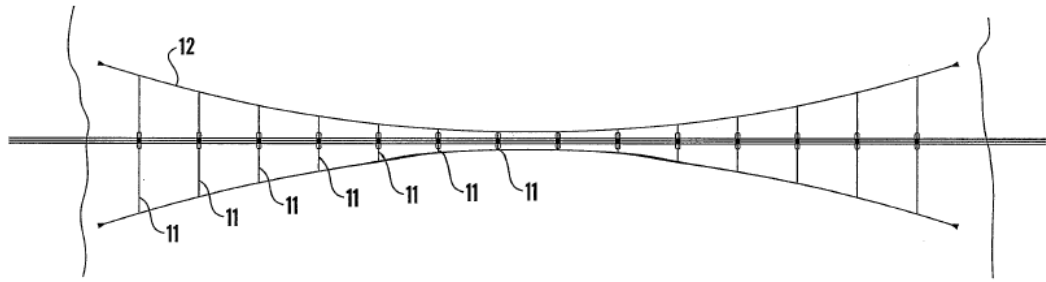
Grundriss, Variante 3 (Aardal, 2005)
